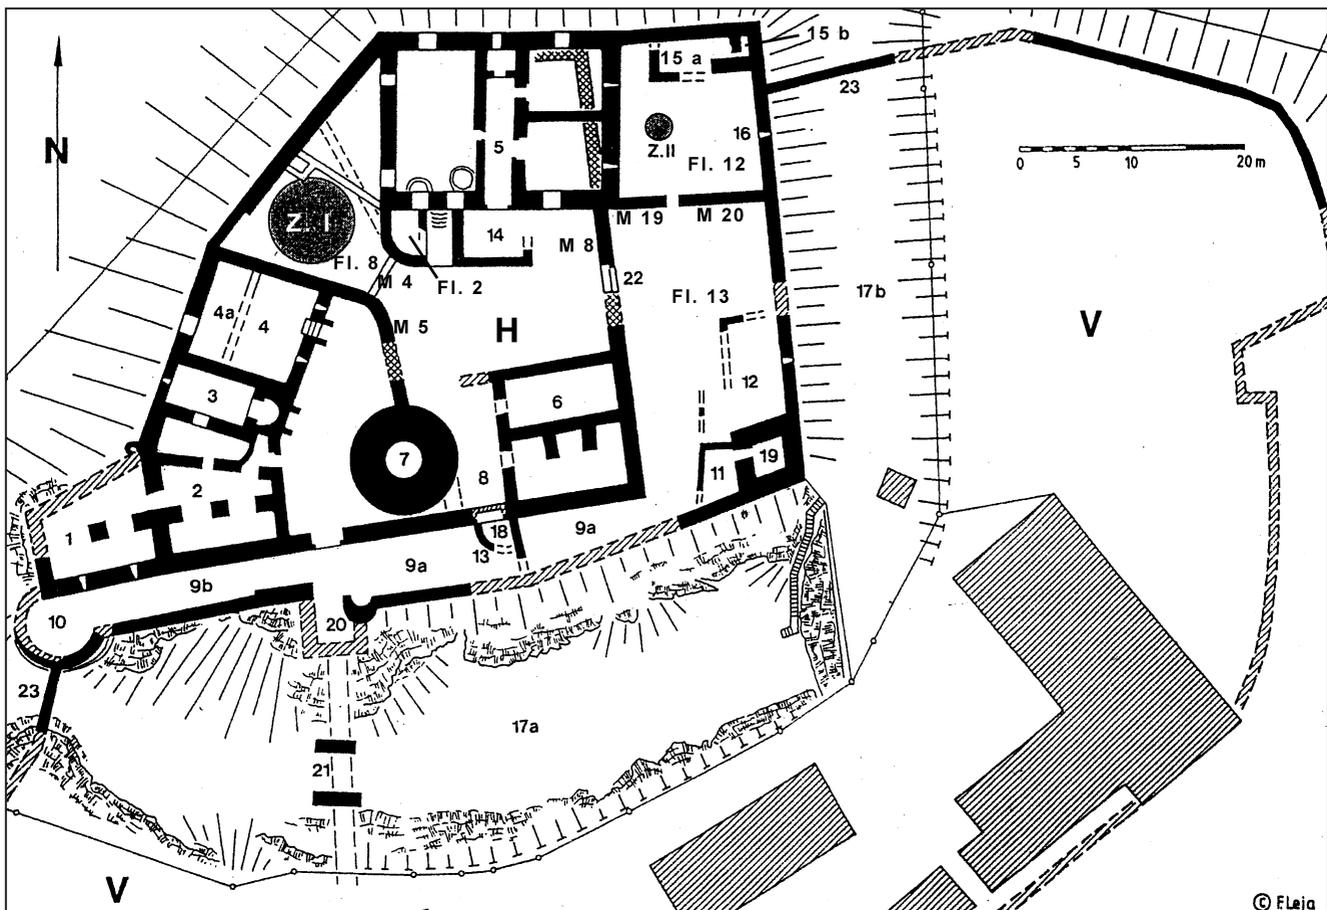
Grundriss der Burg Wolfstein mit Flächen-, Mauern- und Befundnummern.
